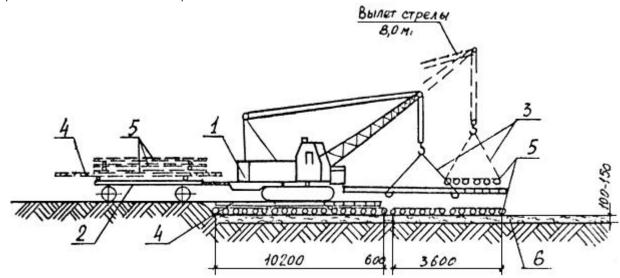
Разрез на стадии укладки щитов лаг и колесопроводов
